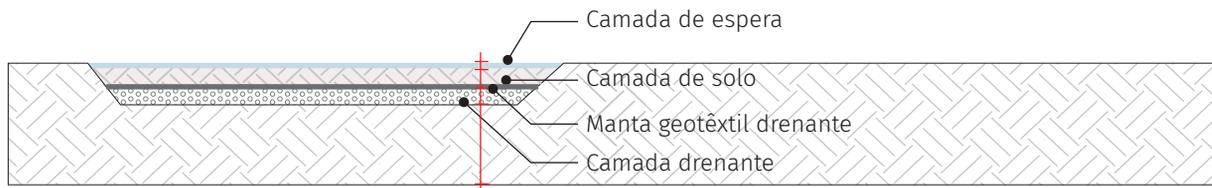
Corte esquemático de facilitador de infiltração do tipo bacia (FCTH, 2024)
